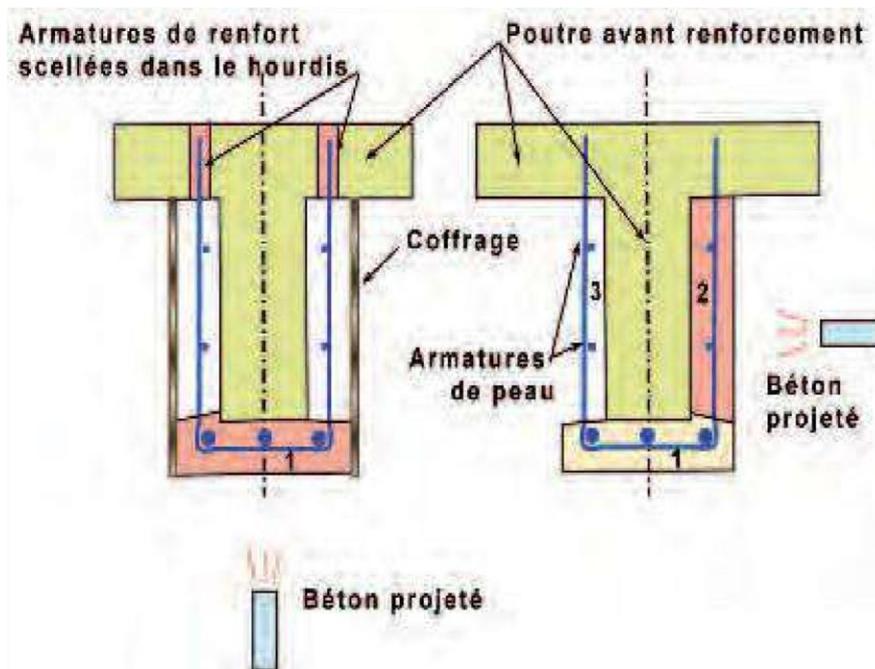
Renforcement avec ajout d'armatures de poutre
